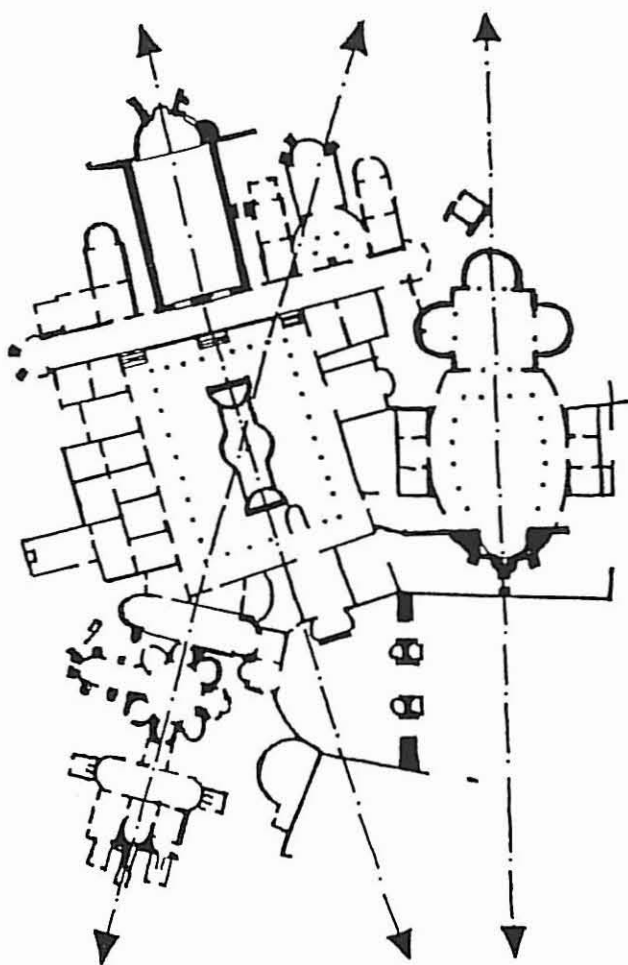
(LXVI) Plan de la Villa de Piazza Armerina. (Sicile).
